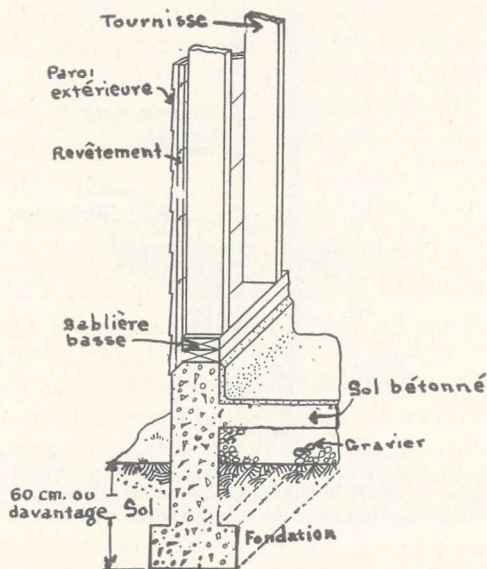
Mur de fondation et sol cimenté convenant à la plupart des bâtiments de ferme.
